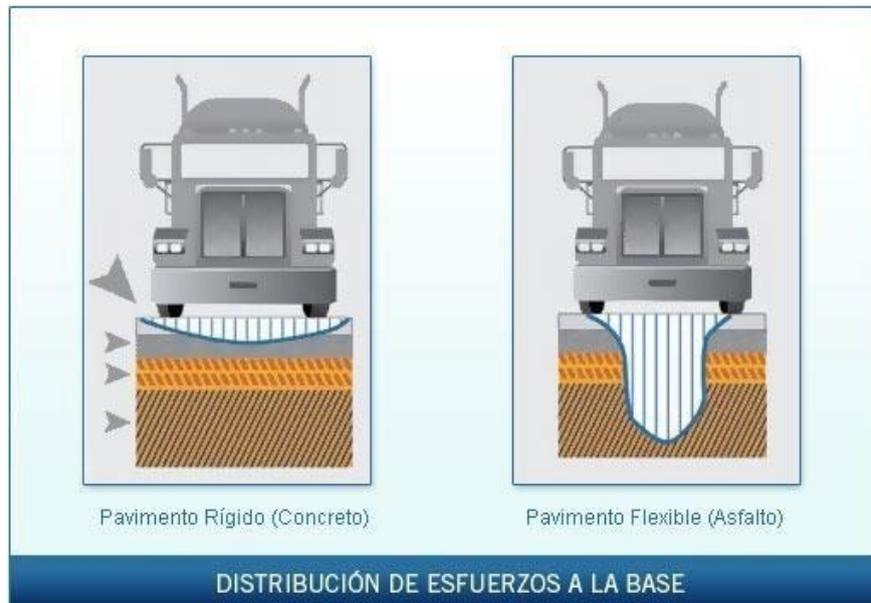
Esquema de distribución de esfuerzos a la base en los pavimentos rígidos y flexibles.
